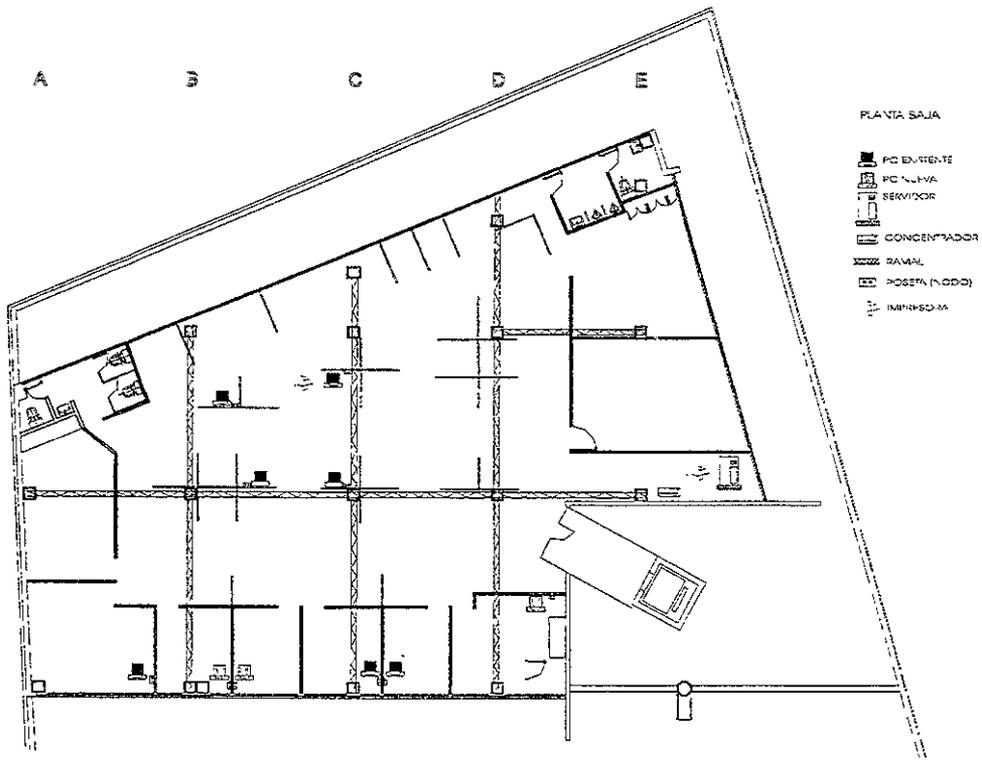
Distribución del equipo en la planta baja del EP.
